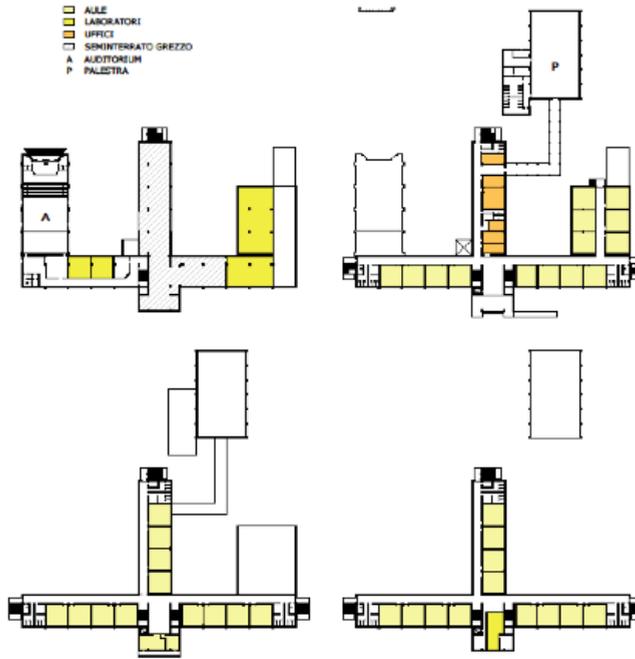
Planimetrie di Rilievo: 1a - Piano Seminterrato; 2a - Piano Terra; 3a - Piano Primo; 4a - Piano Secondo.
